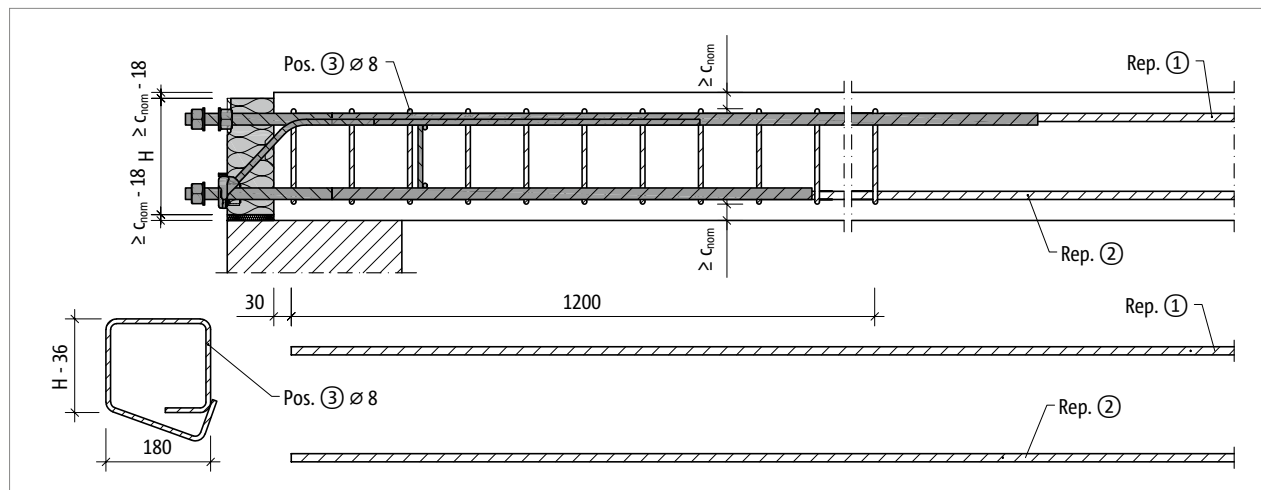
Schöck Isokorb® T type SK-MM2 : armatures à prévoir par le client avec étrier de Ø 8 mm ; vue en coupe
